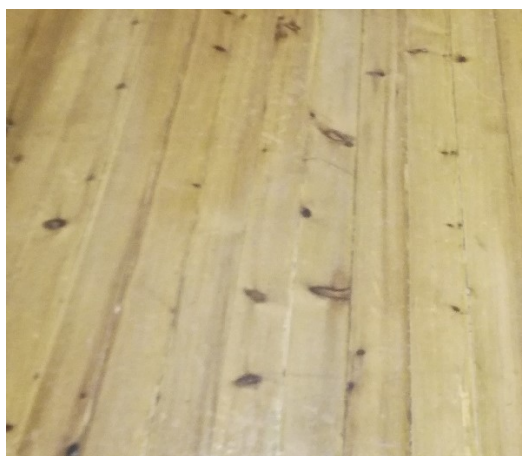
Pavimento piso 1 (Foto do autor, junho 2018)
